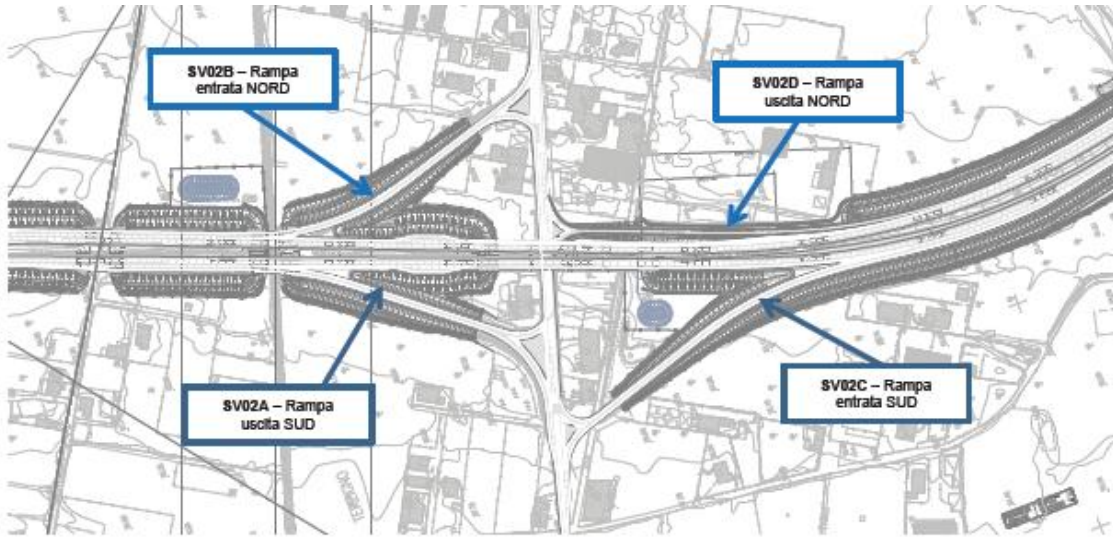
Stralcio Planimetrico dello Svincolo di Terzigno
